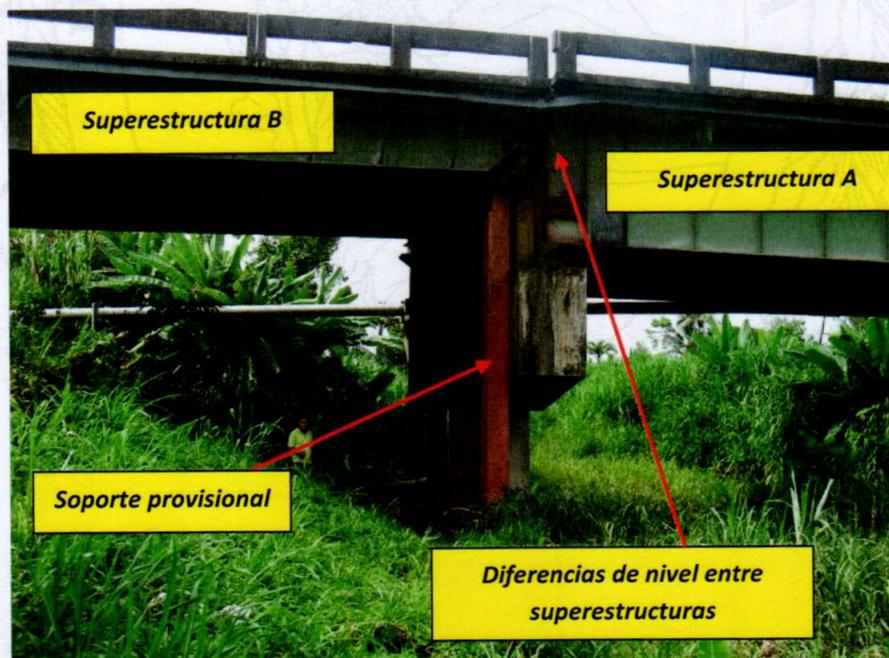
Vista de la primera pila desde el bastión-Oeste donde se muestra el soporte provisional construido para la Superestructura B y las diferencias de nivel entre ambas superestructuras.
